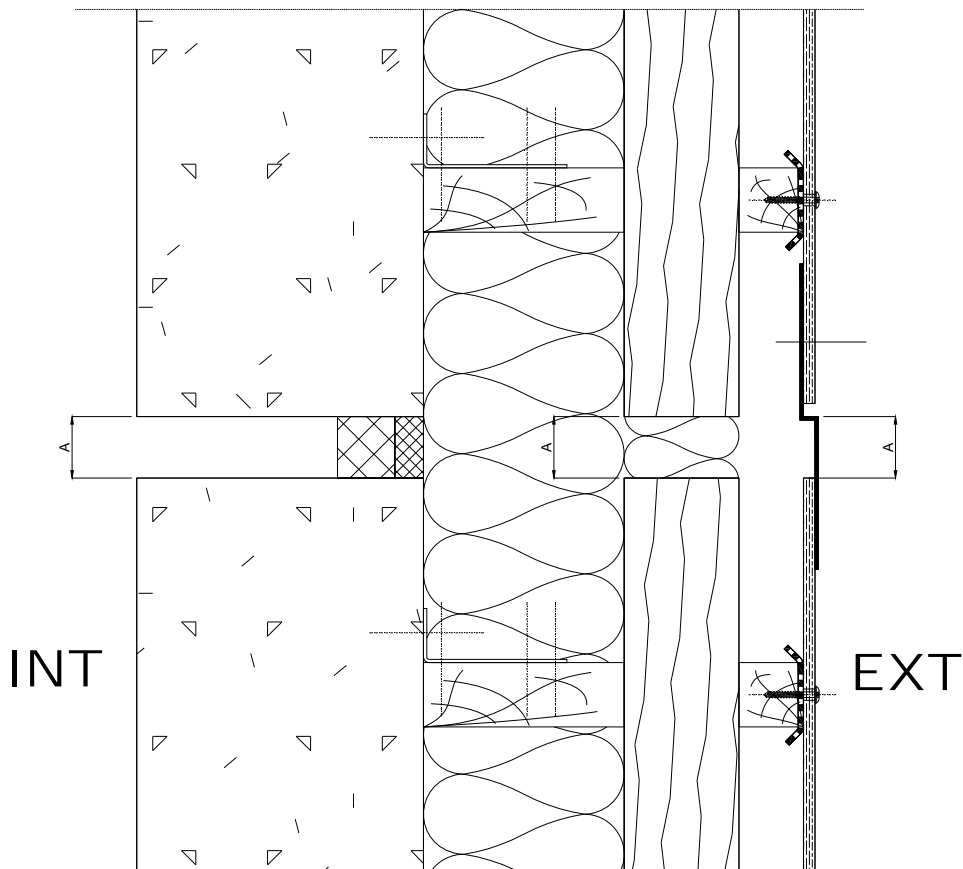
Réseaux croisés sur BA - Joint de dilatation – coupe horizontale
